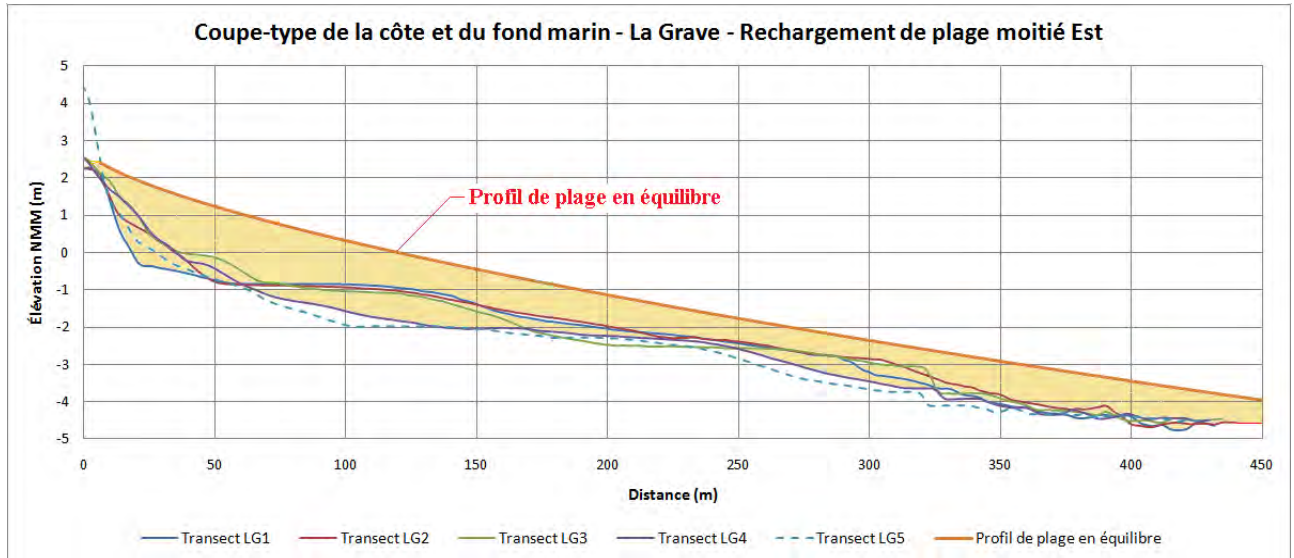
Coupe type d'une plage en équilibre devant la partie est de La Grave (plage)
